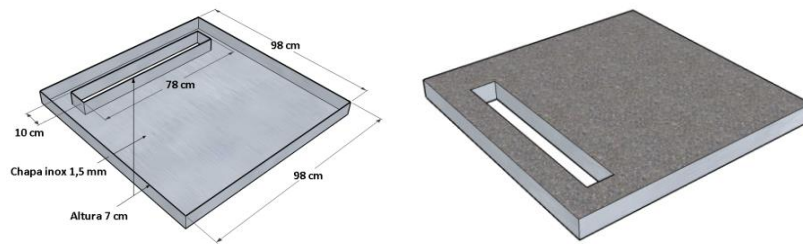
Forma e laje concretada para separar a base e o cinzeiro da fornalha.
